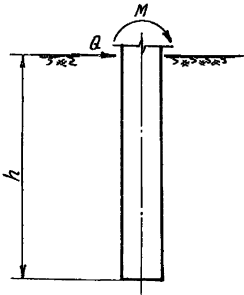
Безригельное закрепление опрокидываемого узкого фундамента глубокого заложения
